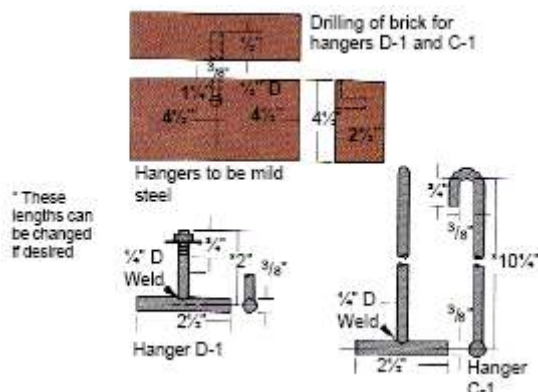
Detalles de construcción suspendida de 4 1/2" de espesor.
